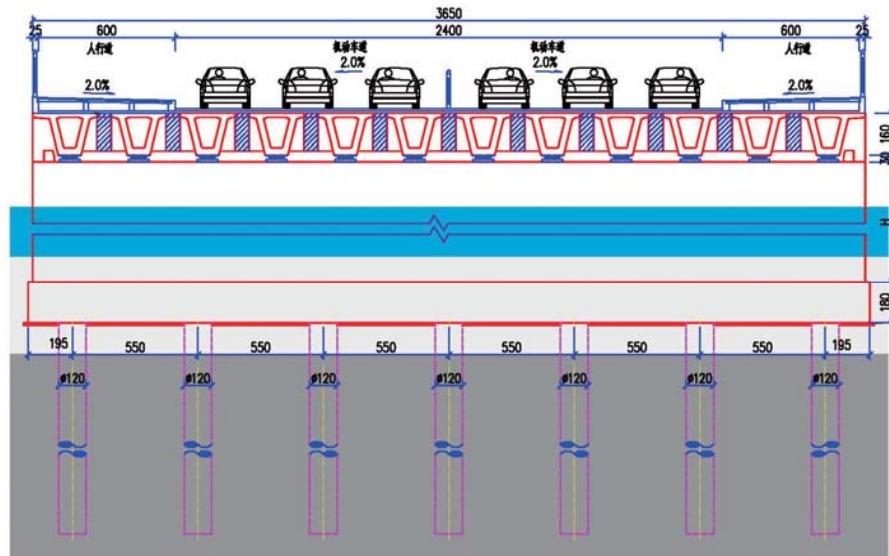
桥梁 B-B 断面图 (单位: cm)
